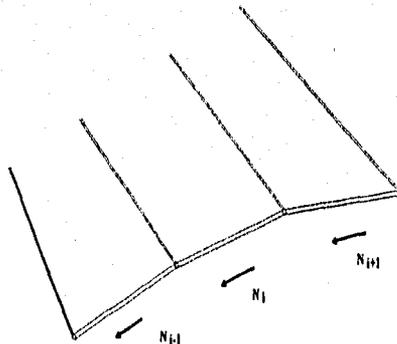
Para un buen balance de cargas permanentes, las fuerzas deben fluir siguiendo exactamente el tablero del puente.
